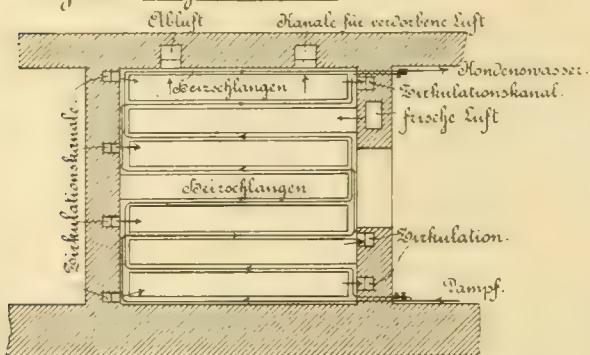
Querschnitt.Fig. 130. Grundriss.
